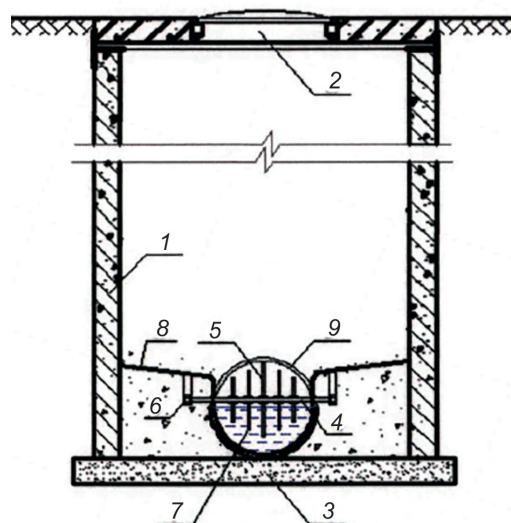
Канализационный колодец с аэратором: 1 — стенка смотрового колодца; 2 — люк; 3 — плита дна колодца; 4 — ось самовращающегося устройства; 5 — наибольший диск; 6 — подшипники; 7 — диск малого диаметра; 8 — опоры вала; 9 — сводная часть самотечного трубопровода
